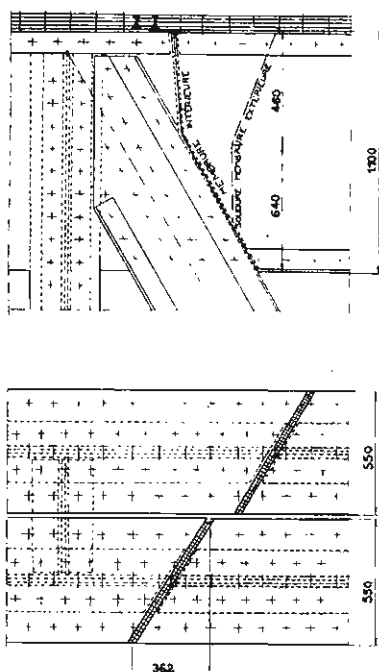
Principe de soudage - Extrémité supérieure du montant 35.
